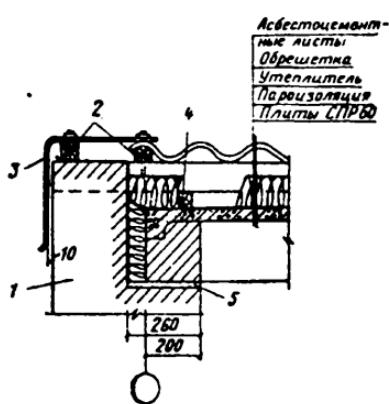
Узел сопряжения стены с асбестоцементной кровлей
